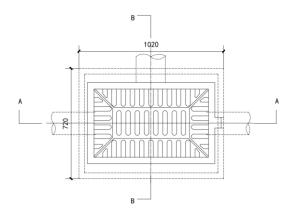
方形溢流口平面图 (单位: mm)
